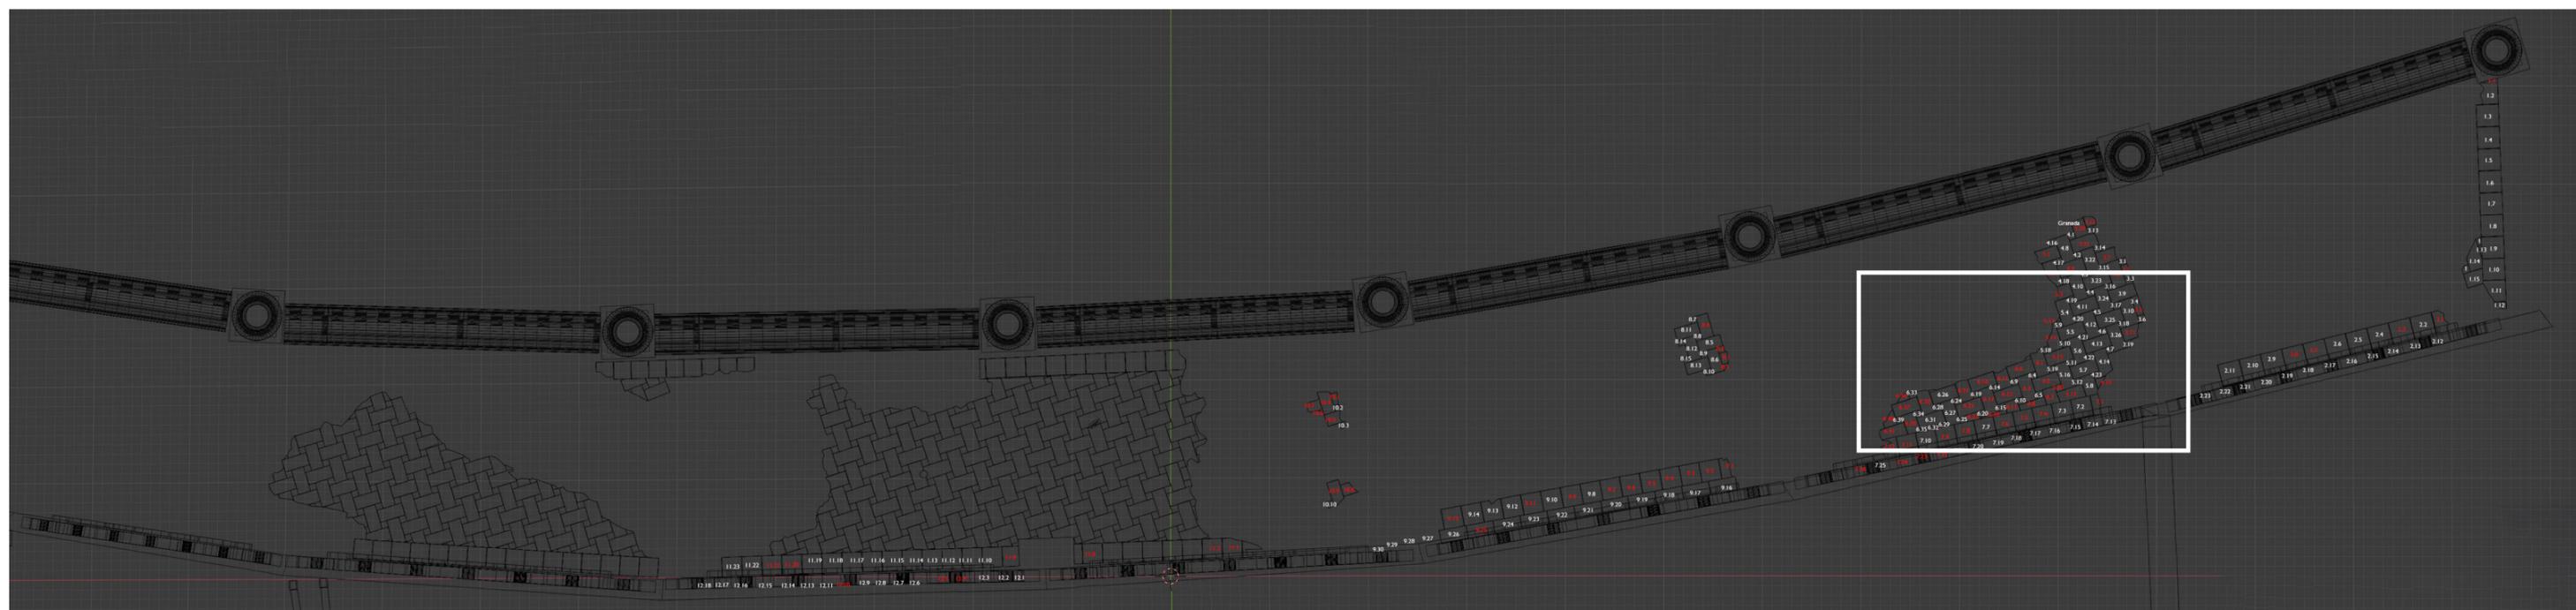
Reconstrucción y mapeo del pavimento cerámico con signatura aplicada (planta).
